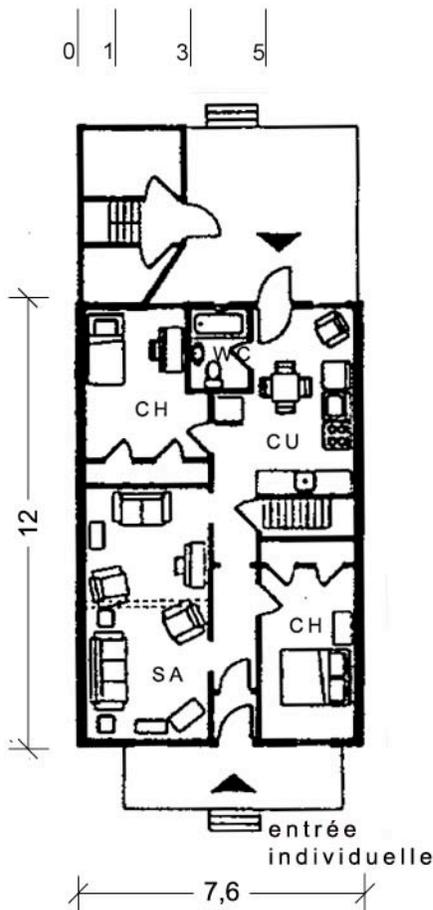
Plan du rez-de-chaussée d'un triplex typique (Després et Larochelle, 1996)
